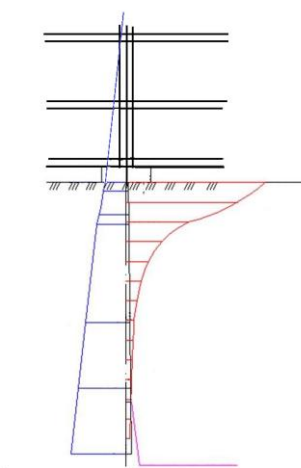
Определение осадок фундамента на естественном основании под колонну
